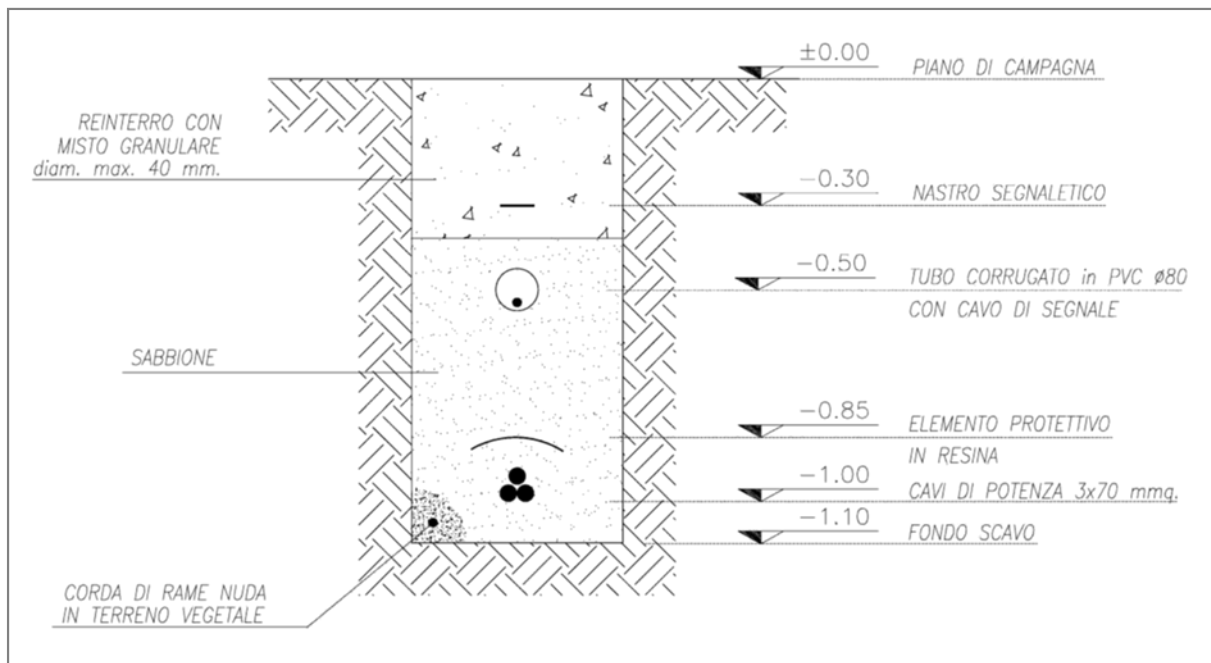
Sezione scavo tipo per aree non soggette ad attraversamenti
